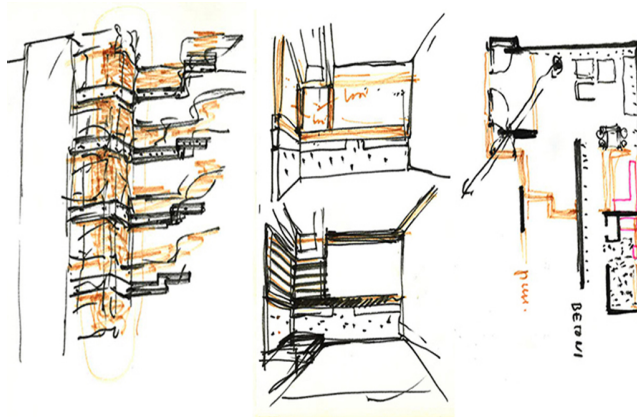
Croquis del exterior de la envolvente y del interior de las habitaciones exteriores, junto con su posición en la planta de la vivienda, bloques 181 y 182. Ref. 9/R [Fuente: MFA]
